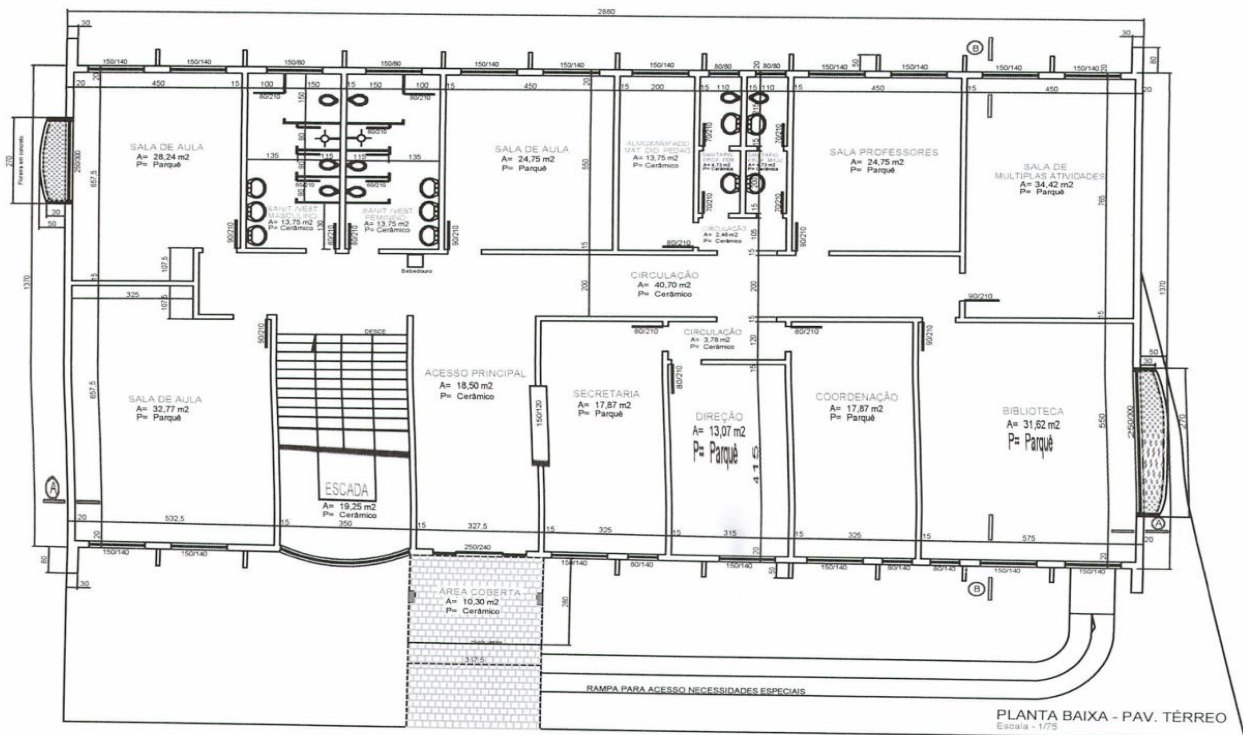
Planta Baixa – Escola A – Pavimento Inferior
